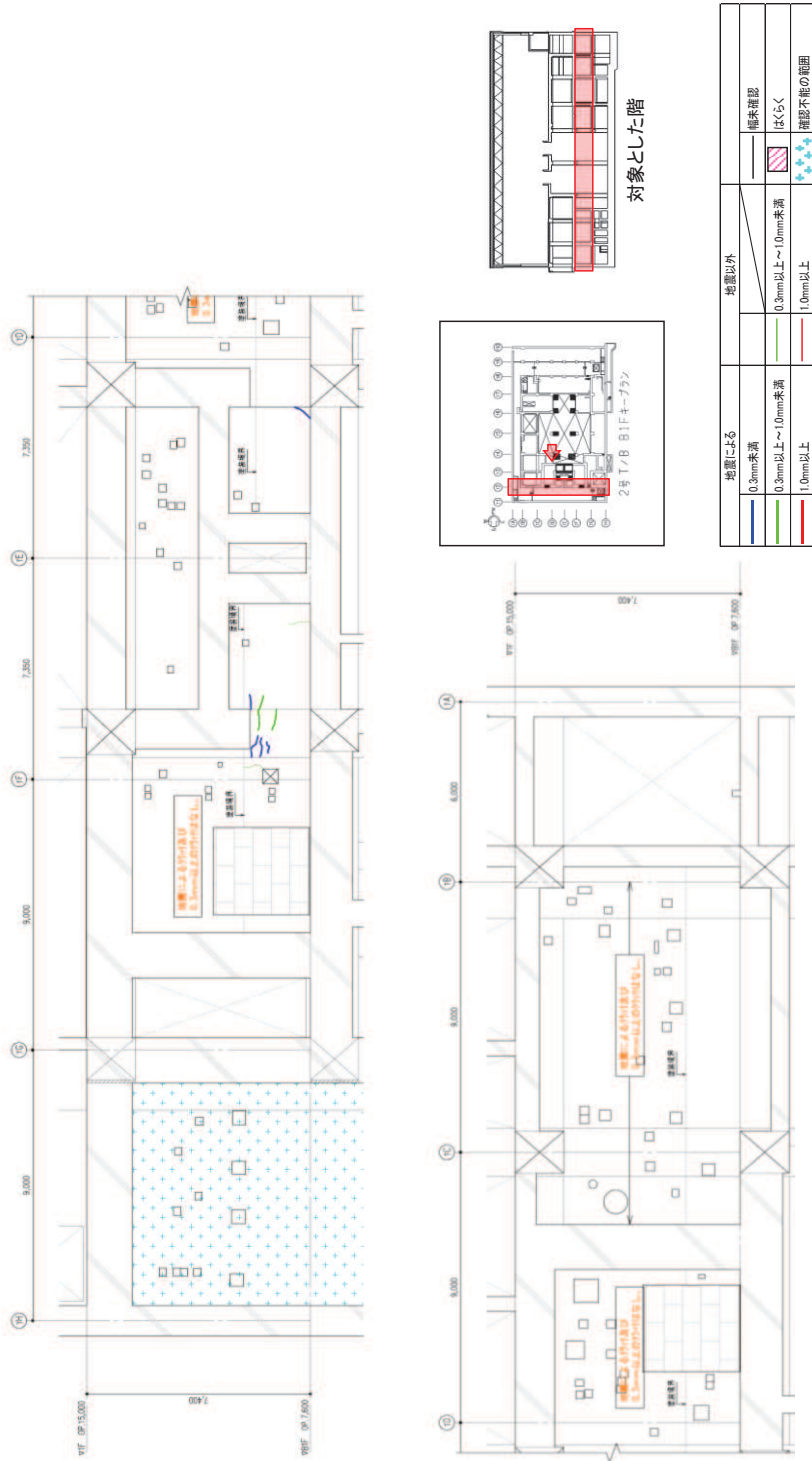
タービン建屋のひび割れ分布 耐震壁 (18) 地下 1 階 T2 通り
